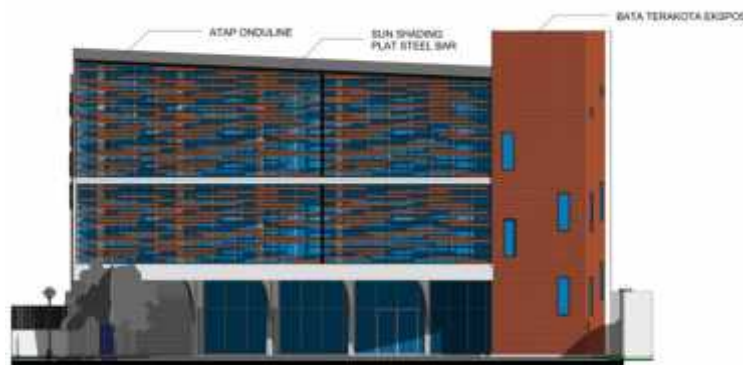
Peninggian bangunan di bagian kanan bangunan (utara) untuk sirkulasi vertikal bangunan.
